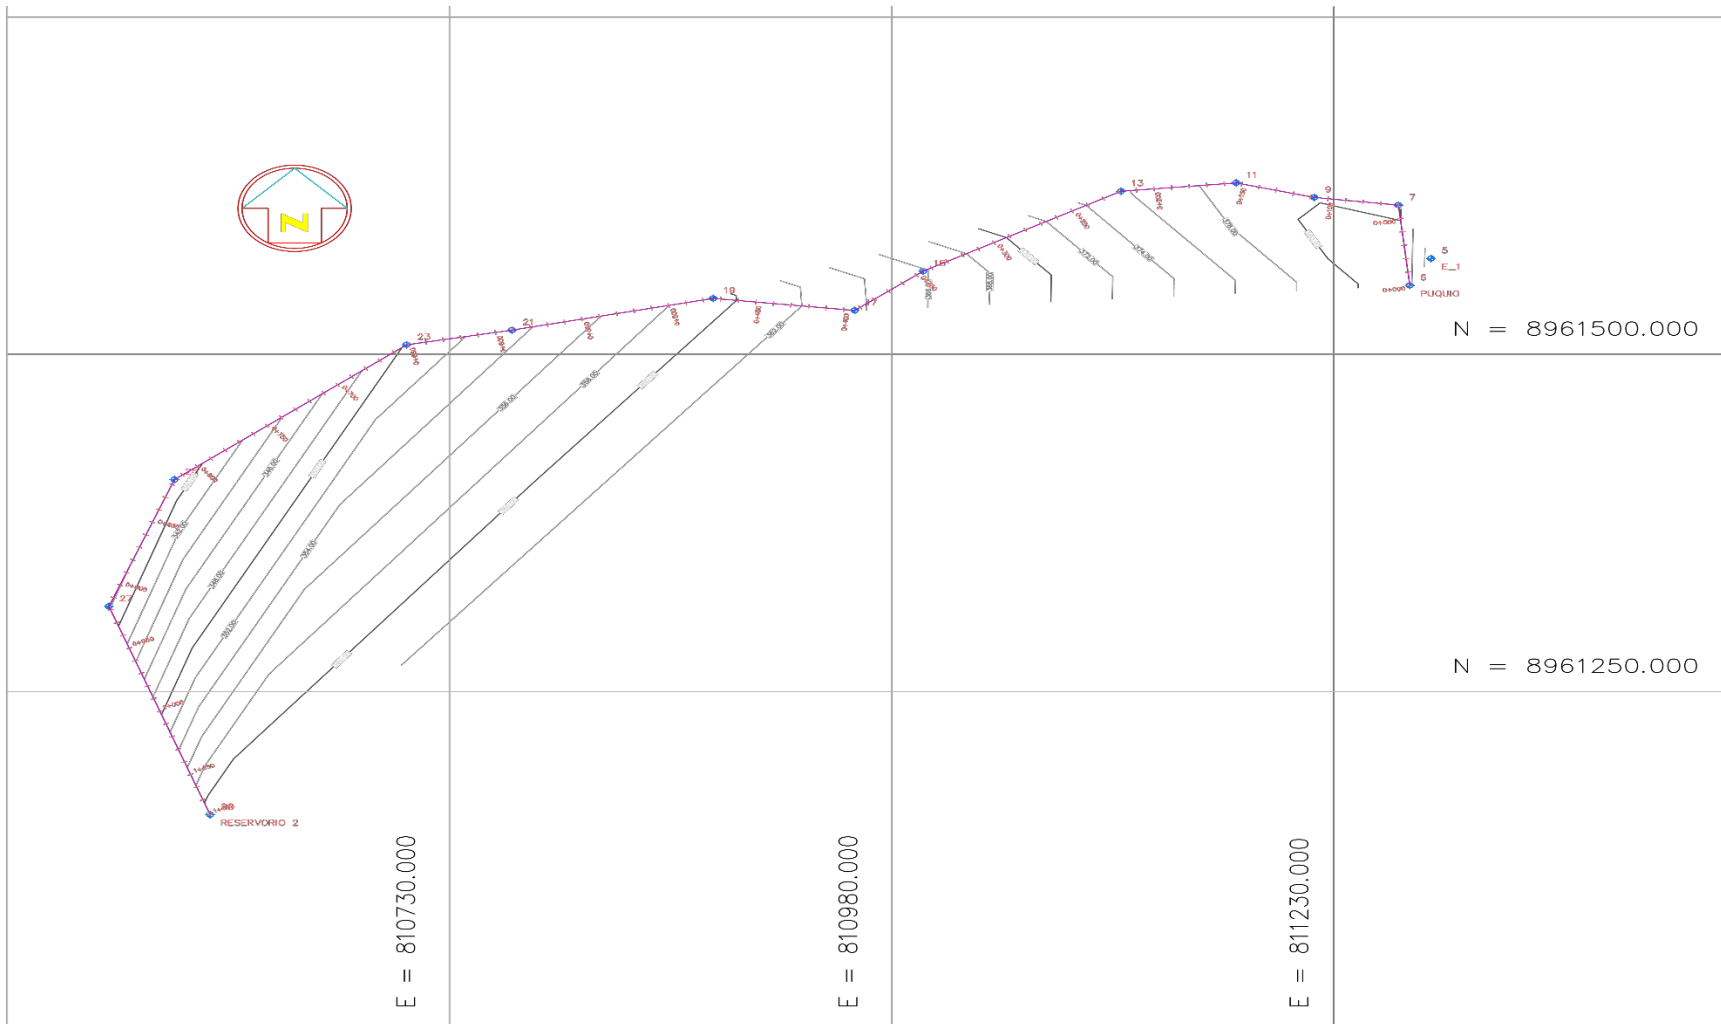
Plano de planta de la línea de conducción del caserío El Olivar.
